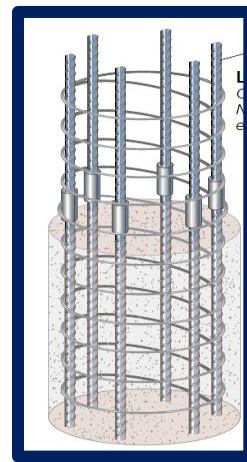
Conector entre barras para alcanzar longitudes deseadas.
